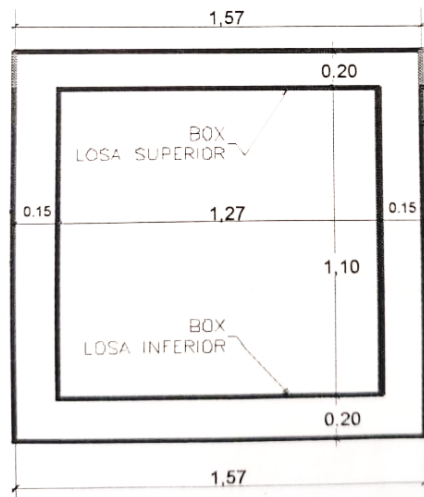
Sección típica para el diseño de Cámara de protección de la tubería subfluvial. Imagen tomada de las memorias de cálculo presentadas por la empresa CO2 INGENIERÍA S.A.S.
